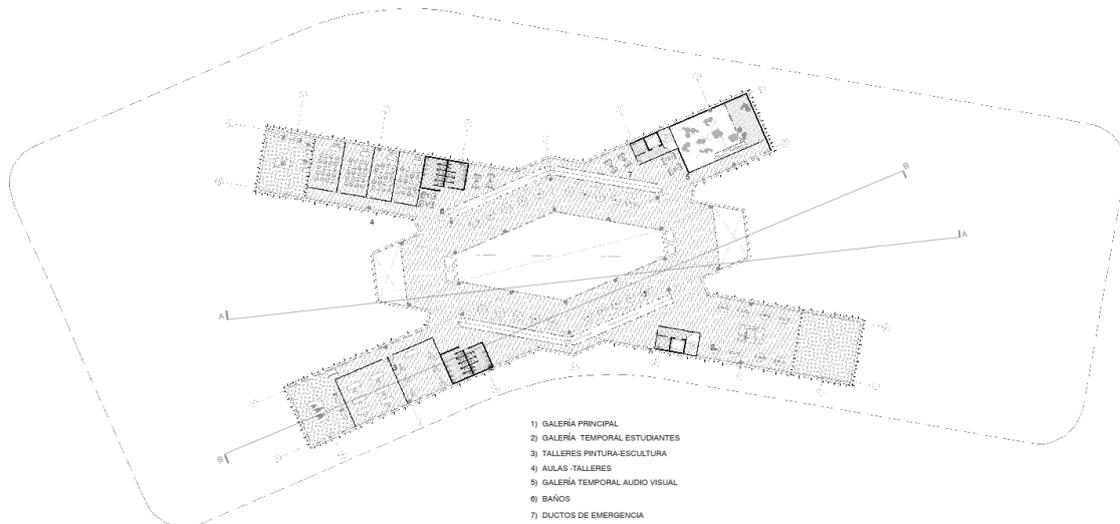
Planta PB + 3.50m. Elaboración propia
